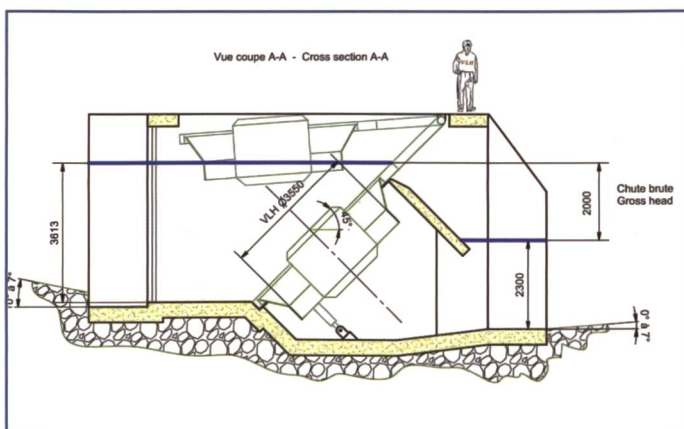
Typische Einbausituation des VLH-Konzepts; die Maschine kann zu Revisionszwecken hydraulisch aus dem Wasser gehoben werden.
